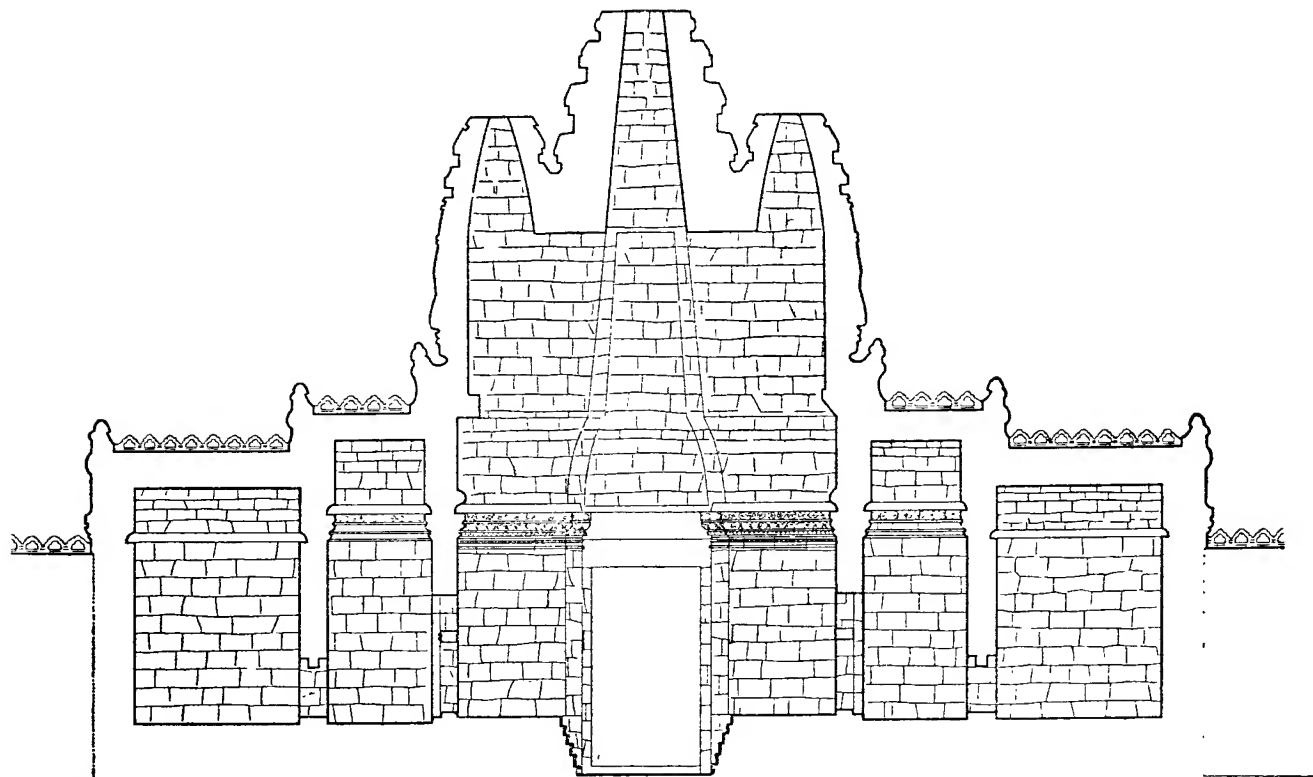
Coupe longitudinale sur la porte des Morts. (Dessin de Jean Commaille.)
